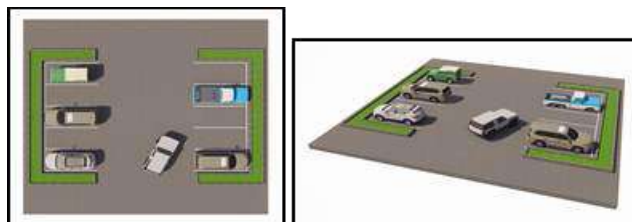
17 Alternatif 2 Penempatan Parkiran
